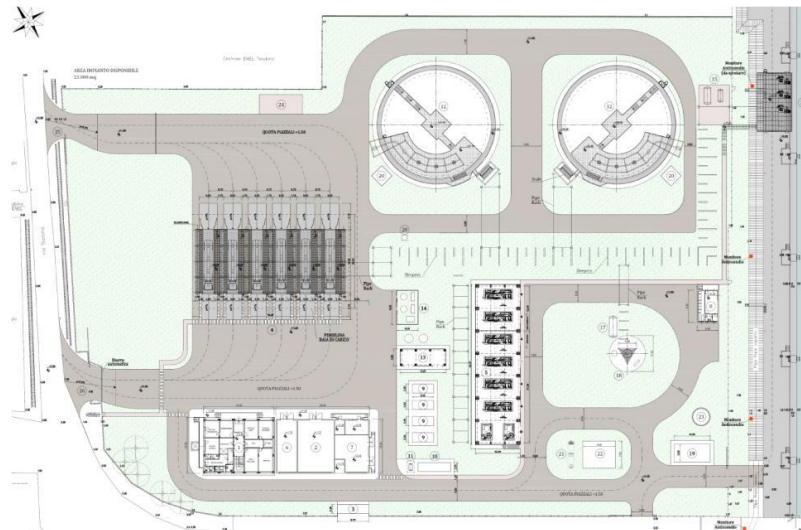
Planimetria di progetto con evidenza delle aree pavimentate e delle aree verdi
